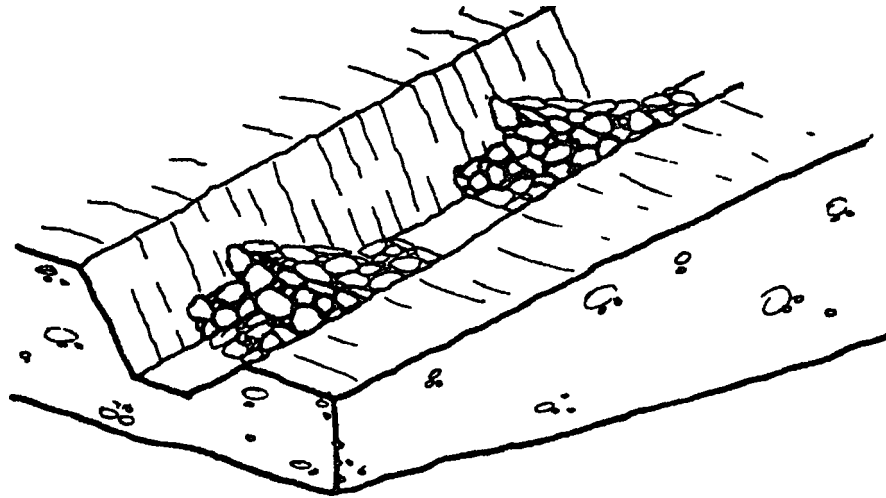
PROTECCIÓN DE DESAGÜE POR PRESAS DE PIEDRA
